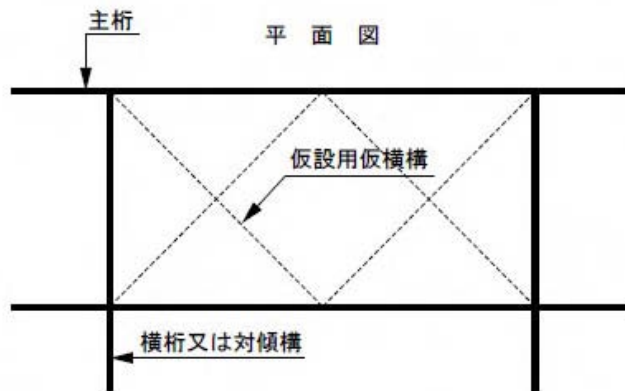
コンクリート打ち込み時、合成桁上フランジ座屈防止に使う仮の横構、
